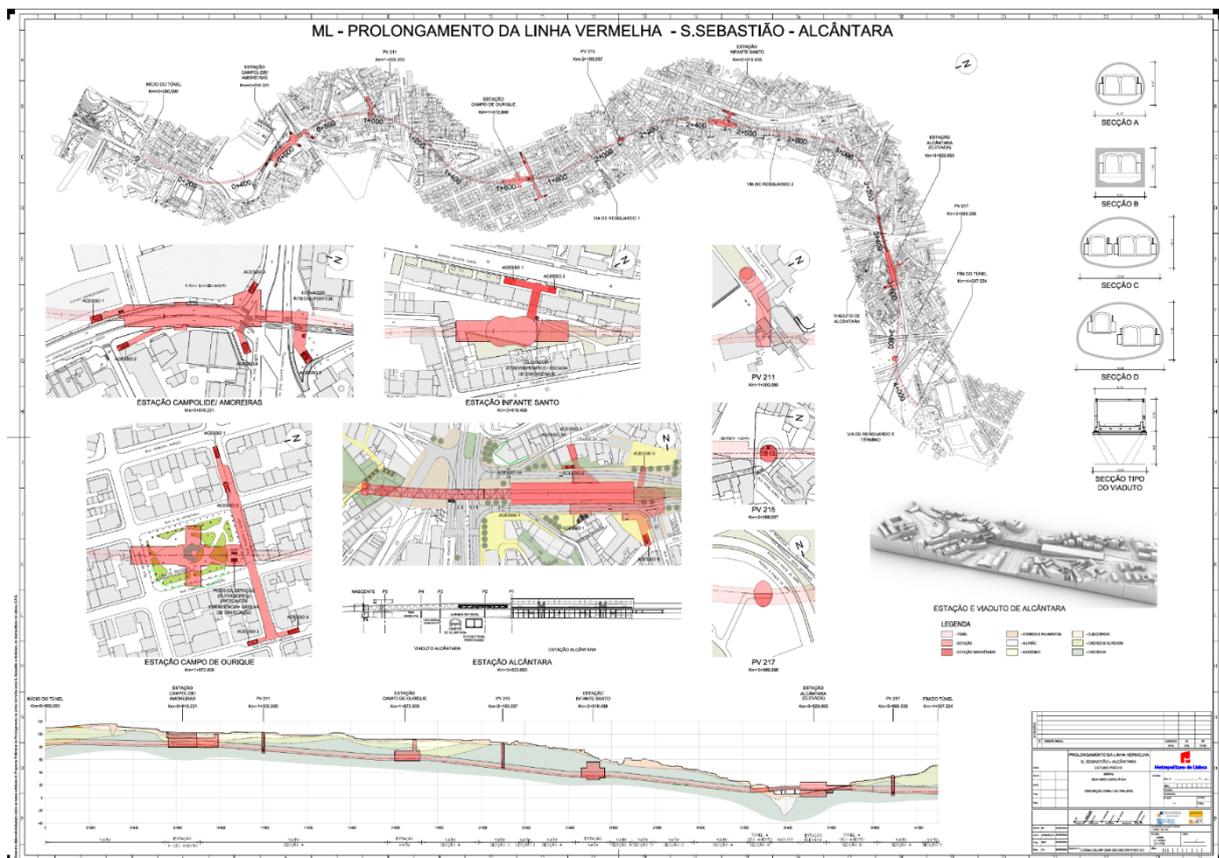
Planta de localização Geral do Projeto – LVSSA MSA PE GER 000 000 DW 010010 0
